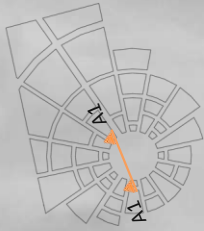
| Sonnenschutzsystem | Grundriss
